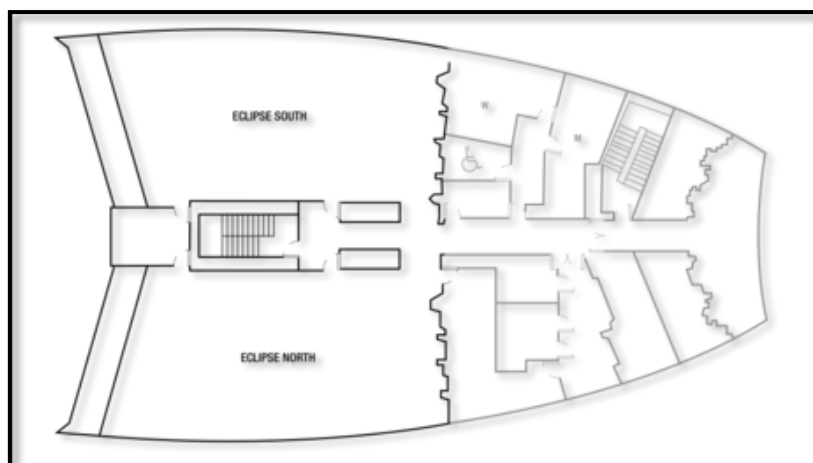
Plan du 26<sup>me</sup> étage Hôtel W
